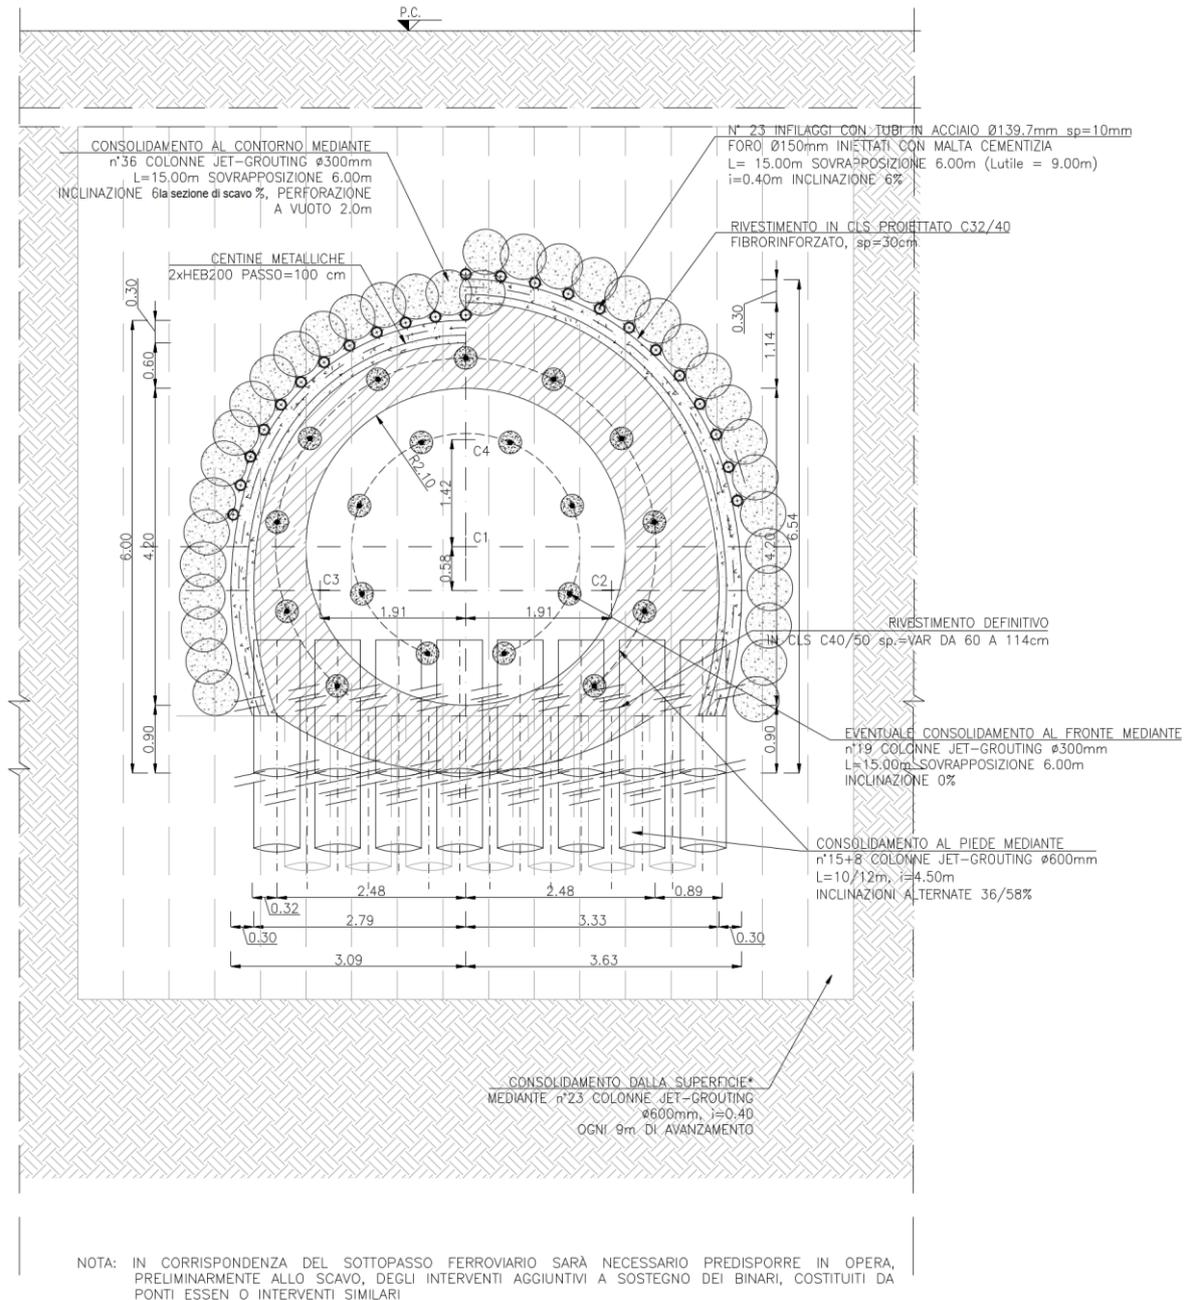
Sezione Tipo GI S2: Geometria del cavo e interventi di sostegno (Sezione Trasversale)
